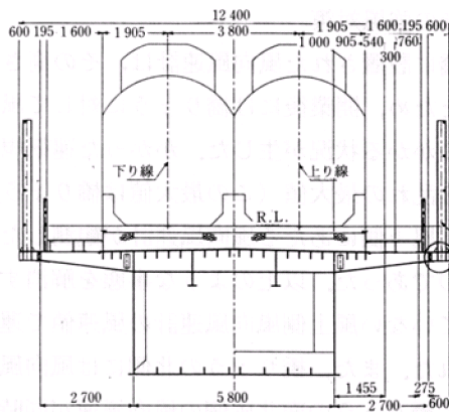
(a) 関空連絡橋の防風柵設置図 (単位: mm)
